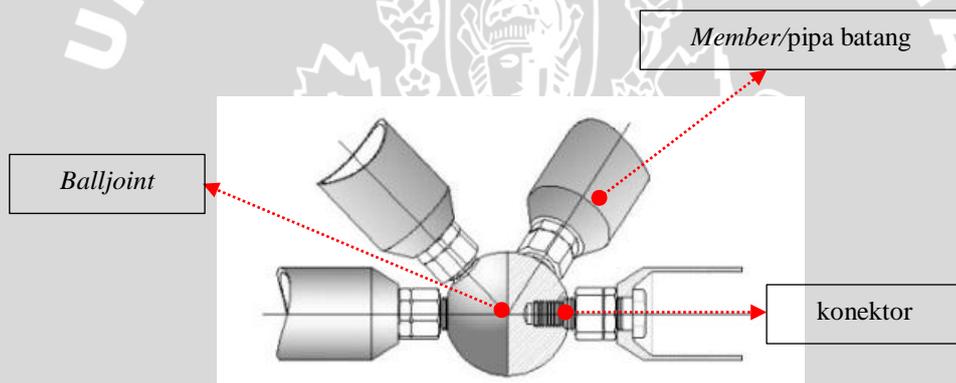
Detail Sambungan Space Frame dan penutup atap
